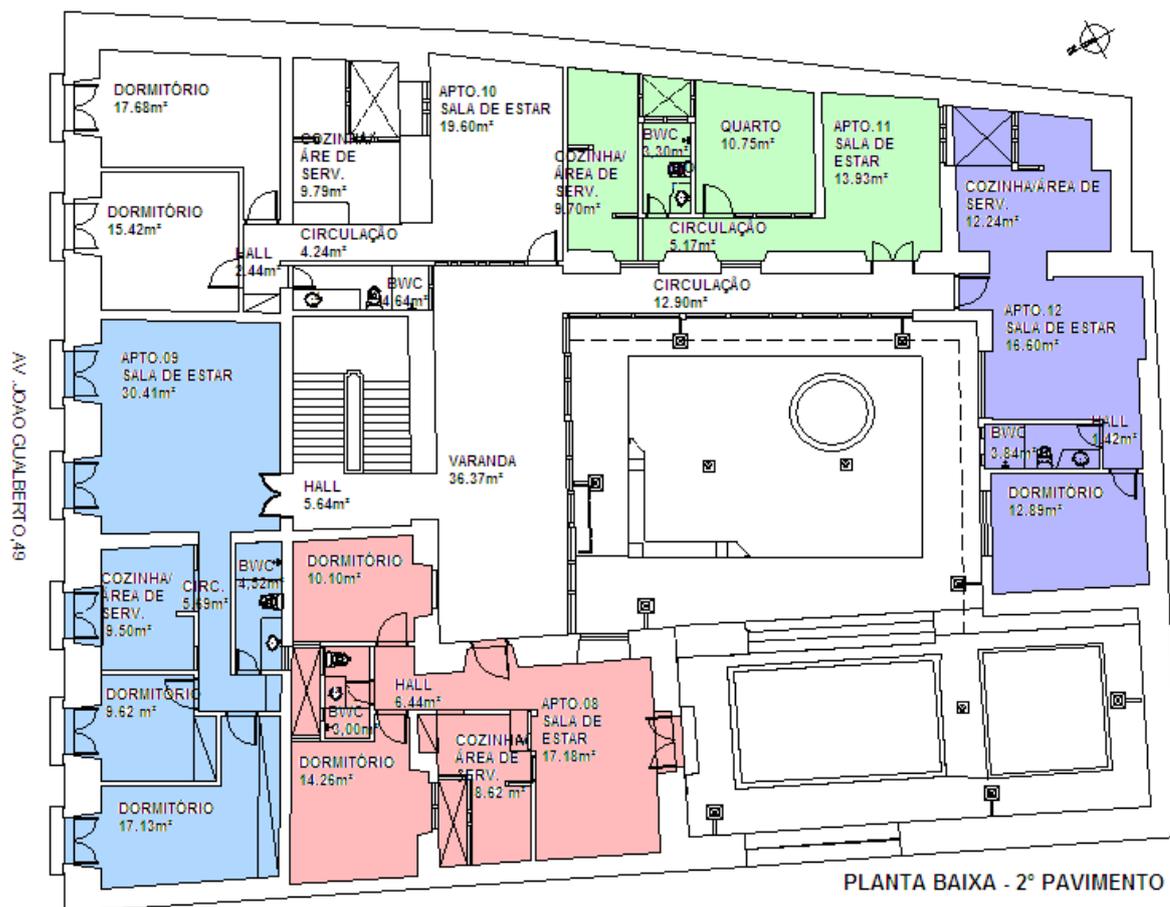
Ilustração de Planta Baixa de Segundo Pavimento.
